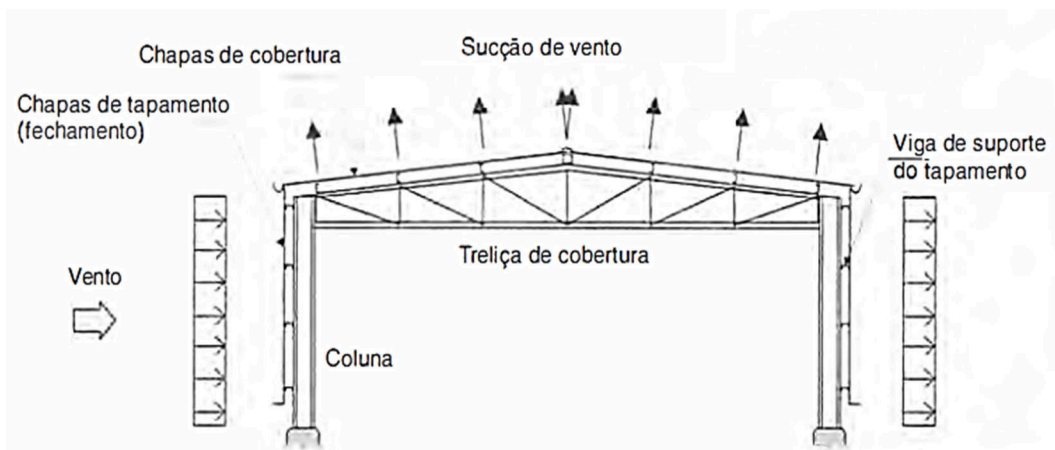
Esquema estrutural de um galpão metálico.
